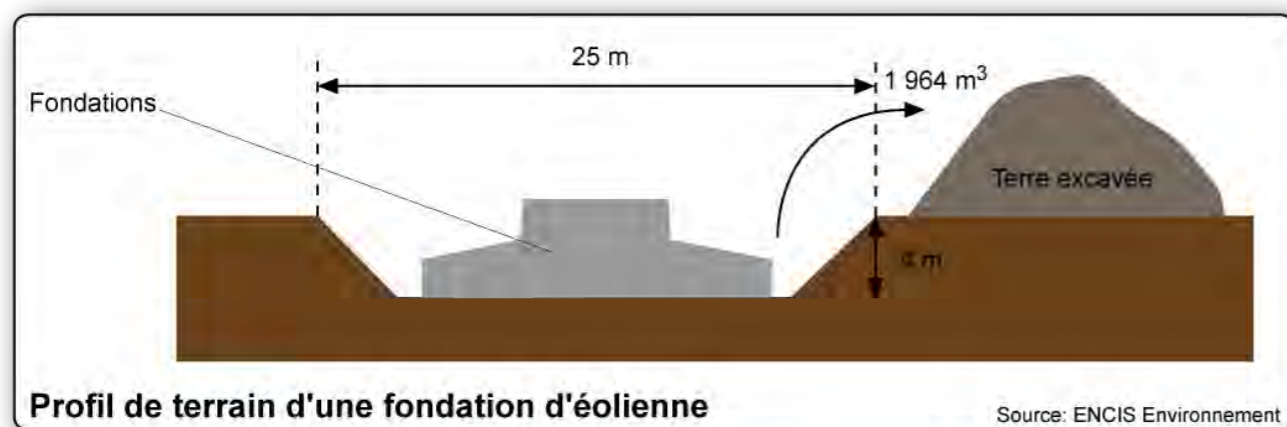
Profil de terrain d'une fondation d'éolienne.
